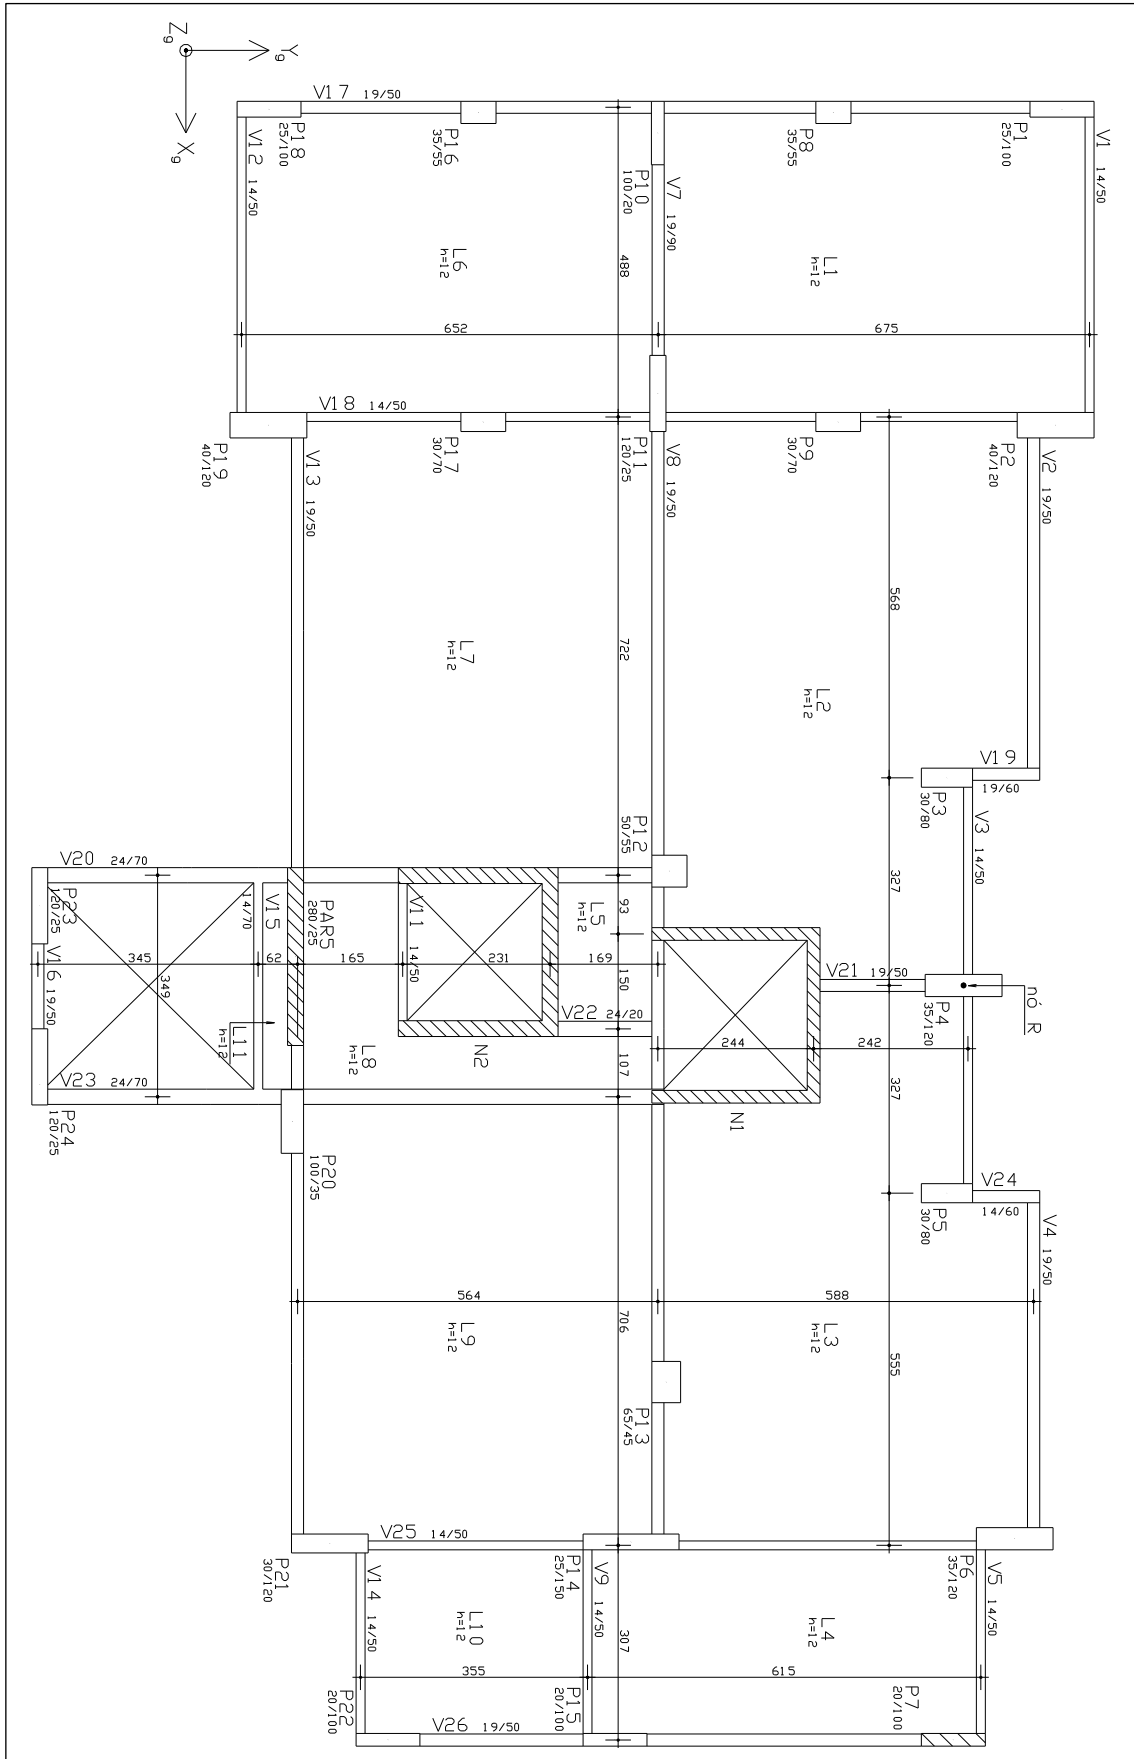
planta baixa do pavimento tipo com a presença de núcleos estruturais – exemplo 4
